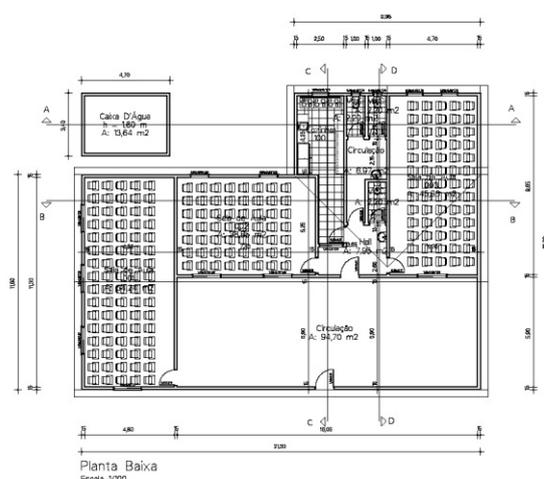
Planta baixa da Escola Antônio Alves Feitosa
